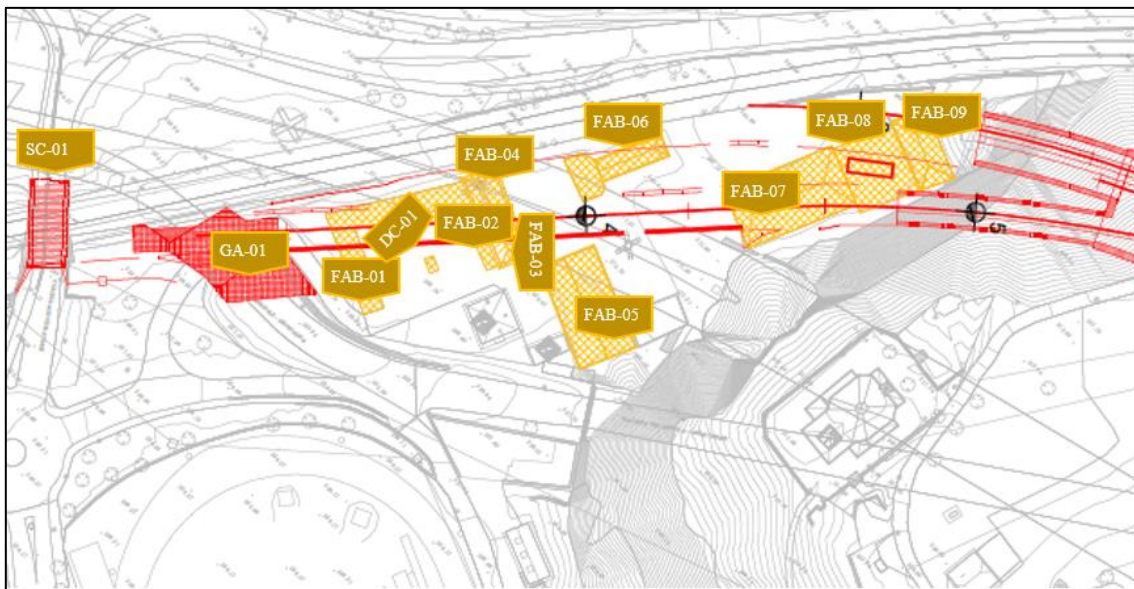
Stralcio planimetrico zona imbocco Galleria del Virgolo
